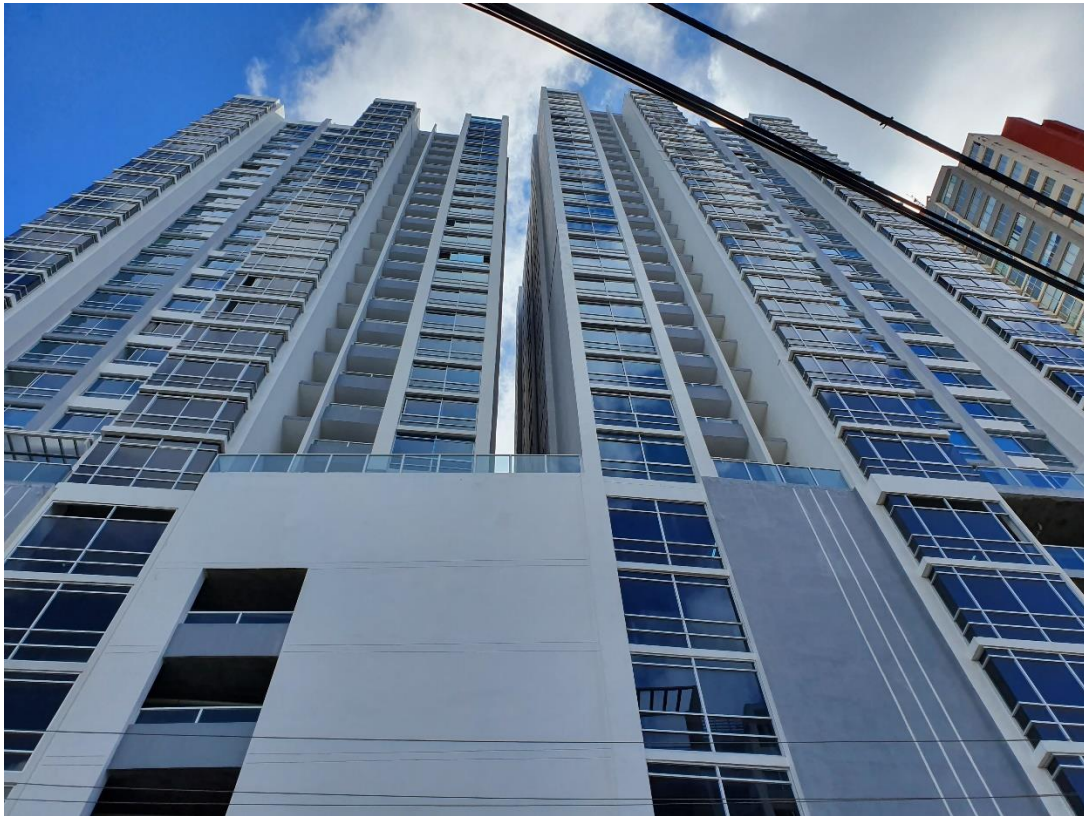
Vista de la parte frontal de la torre 1 y 2.
